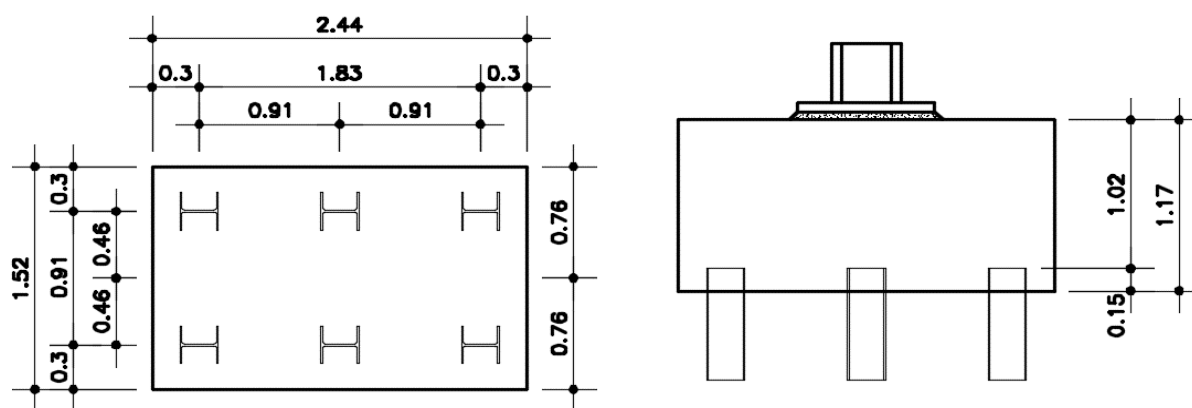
Vista em planta e elevação do Bloco 2, com dimensões em metros
